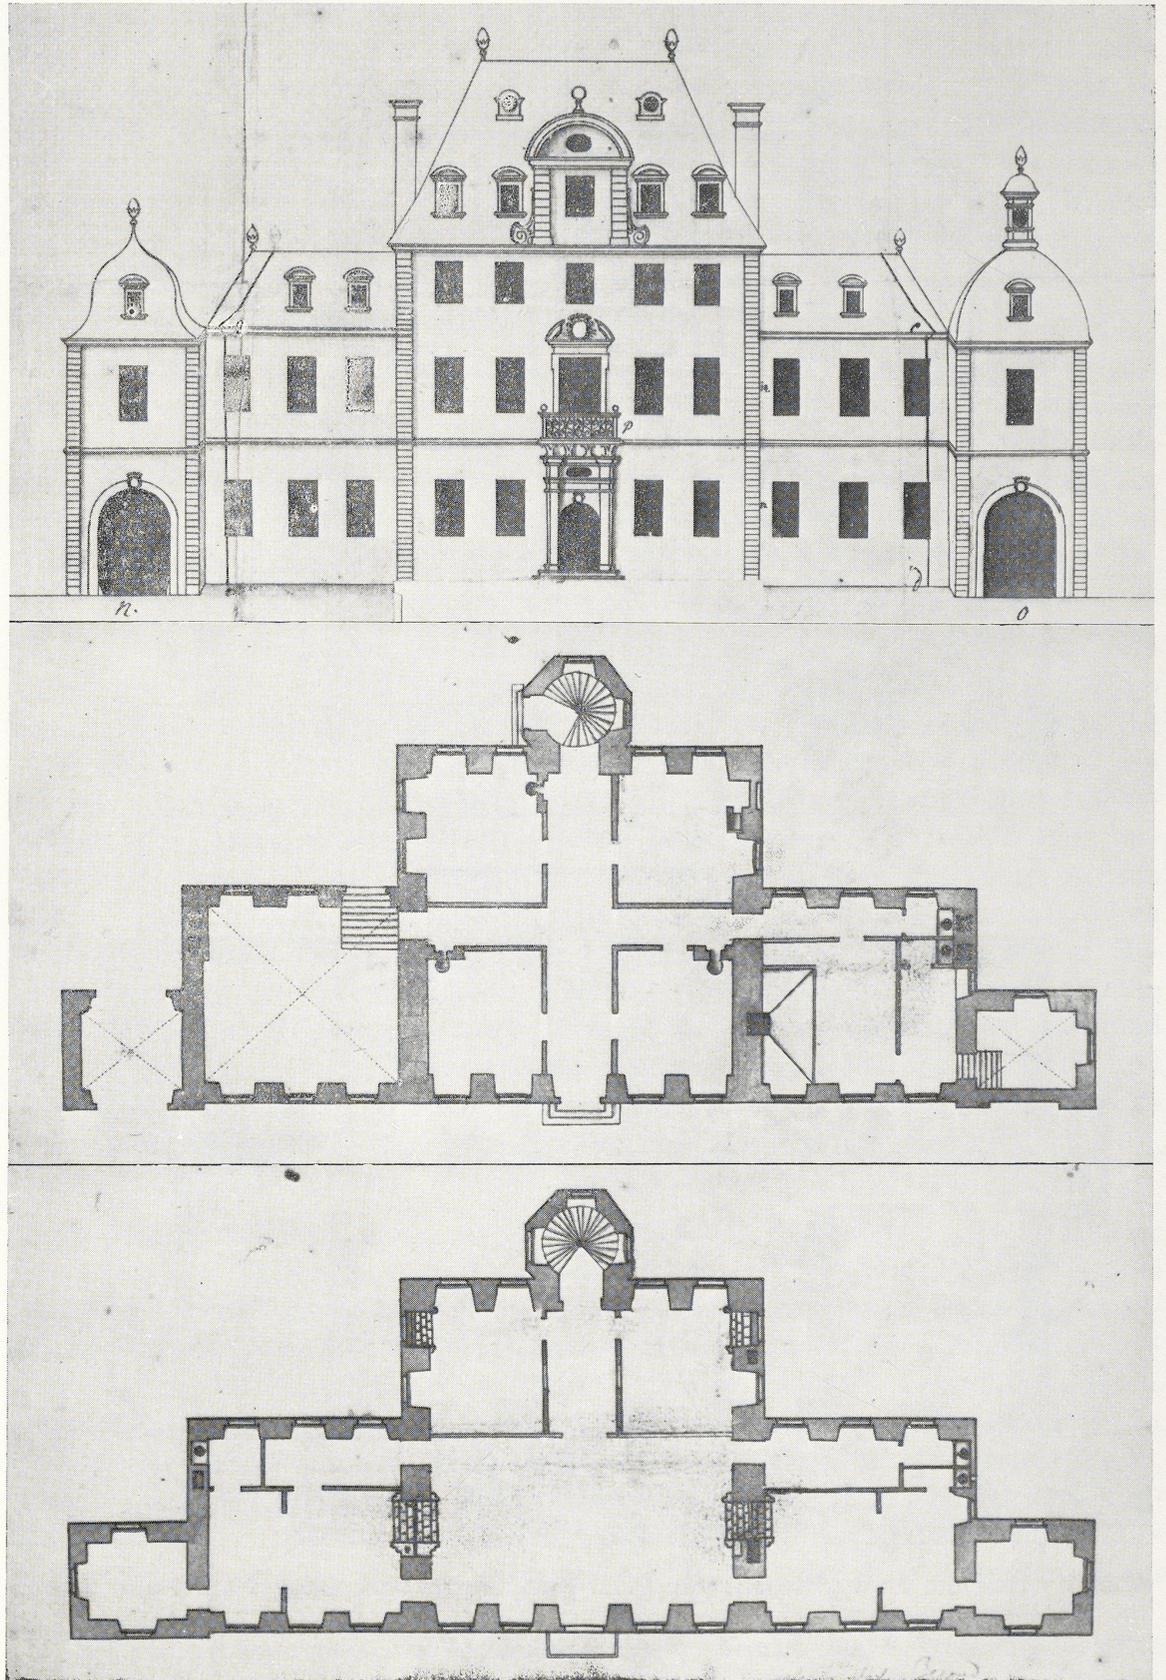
Bekond, zweites Projekt von P.H. Ravensteyn 1710, Aufriß der Gartenfassade und zwei Grundrisse (P5—P7)
